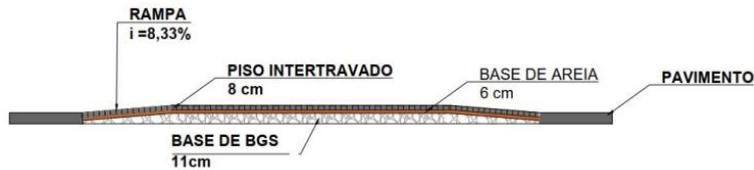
Faixa de travessia de pedestre elevada – Corte AA
